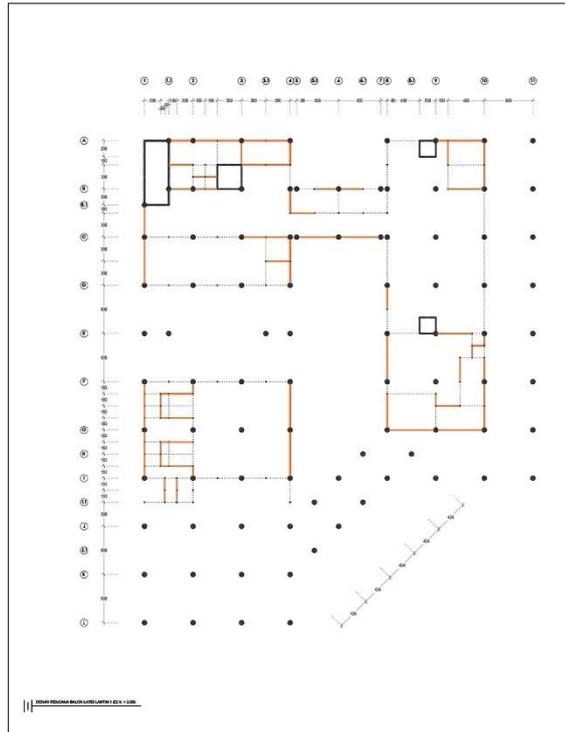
Denah Rencana Balok Elv. + 9.00
